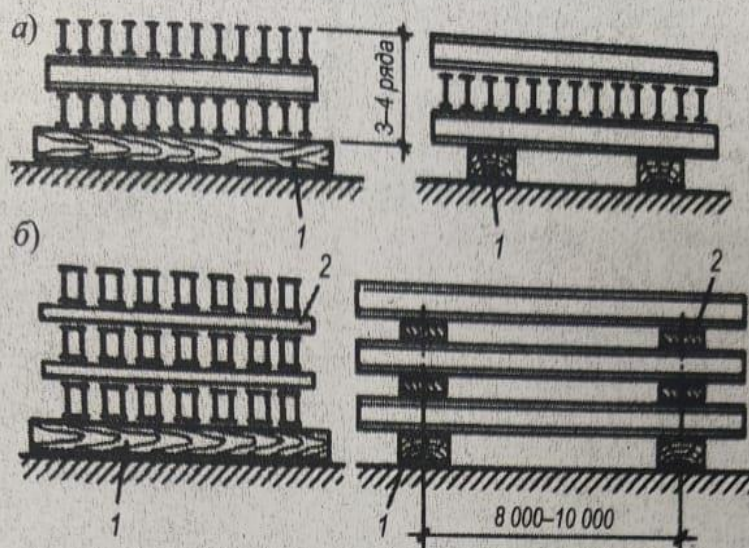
Складирование стальных элементов конструкций в многоярусных штабелях: а — одностенчатых балок с вертикальным положением их стенок; б — двухстенчатых элементов конструкций: 1 — лежни-подкладки; 2 — прокладки
